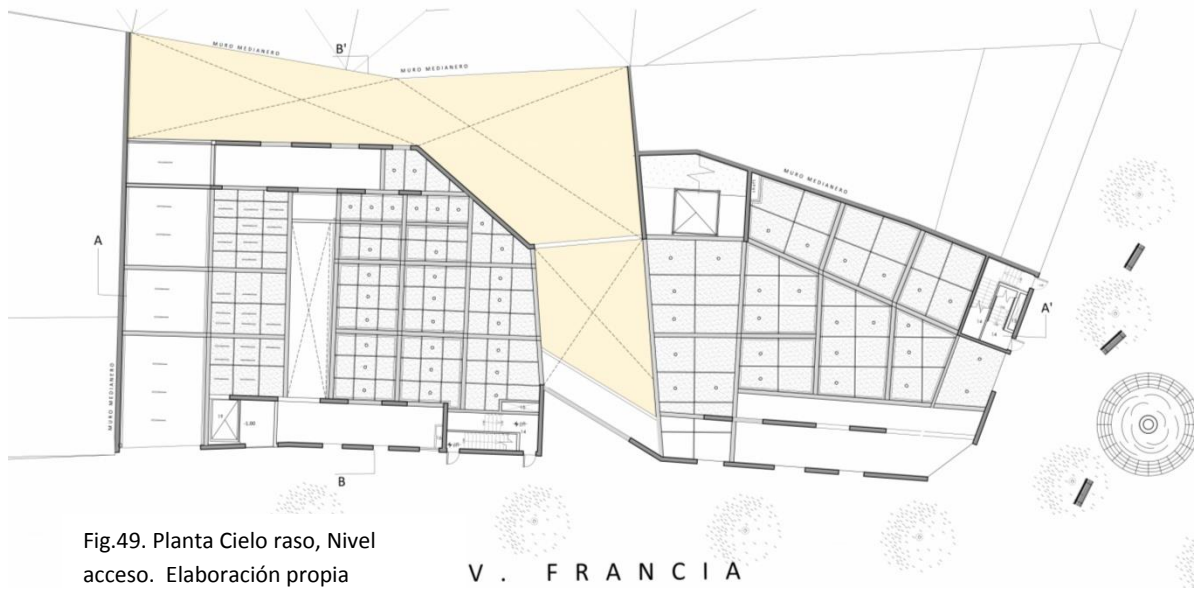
Planta Cielo raso, Nivel acceso. Elaboración propia
